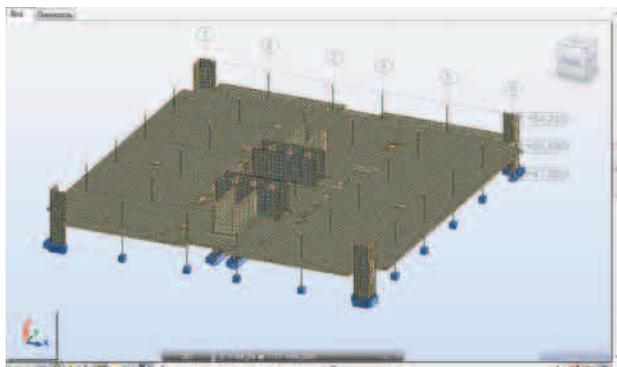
Расчетная схема постнапряженного перекрытия в Robot
